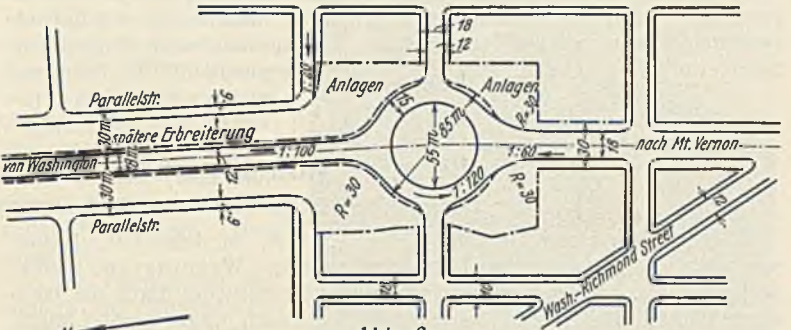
Platzanlage mit Kreisverkehr bei der Einfahrt in die Stadt Alexandria.
